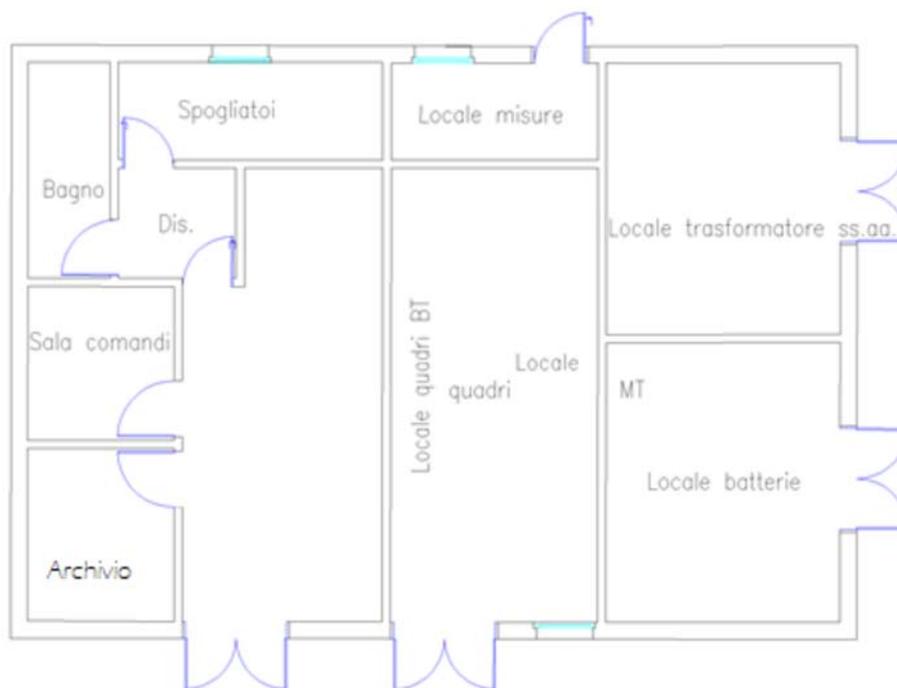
Planimetria locale quadri MT della Stazione Utente
